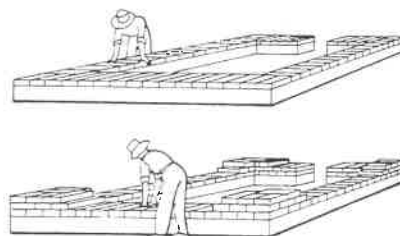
EL MURO DEBE SER CONSTRUIDO UNIFORMEMENTE EN TODA LA LONGITUD
